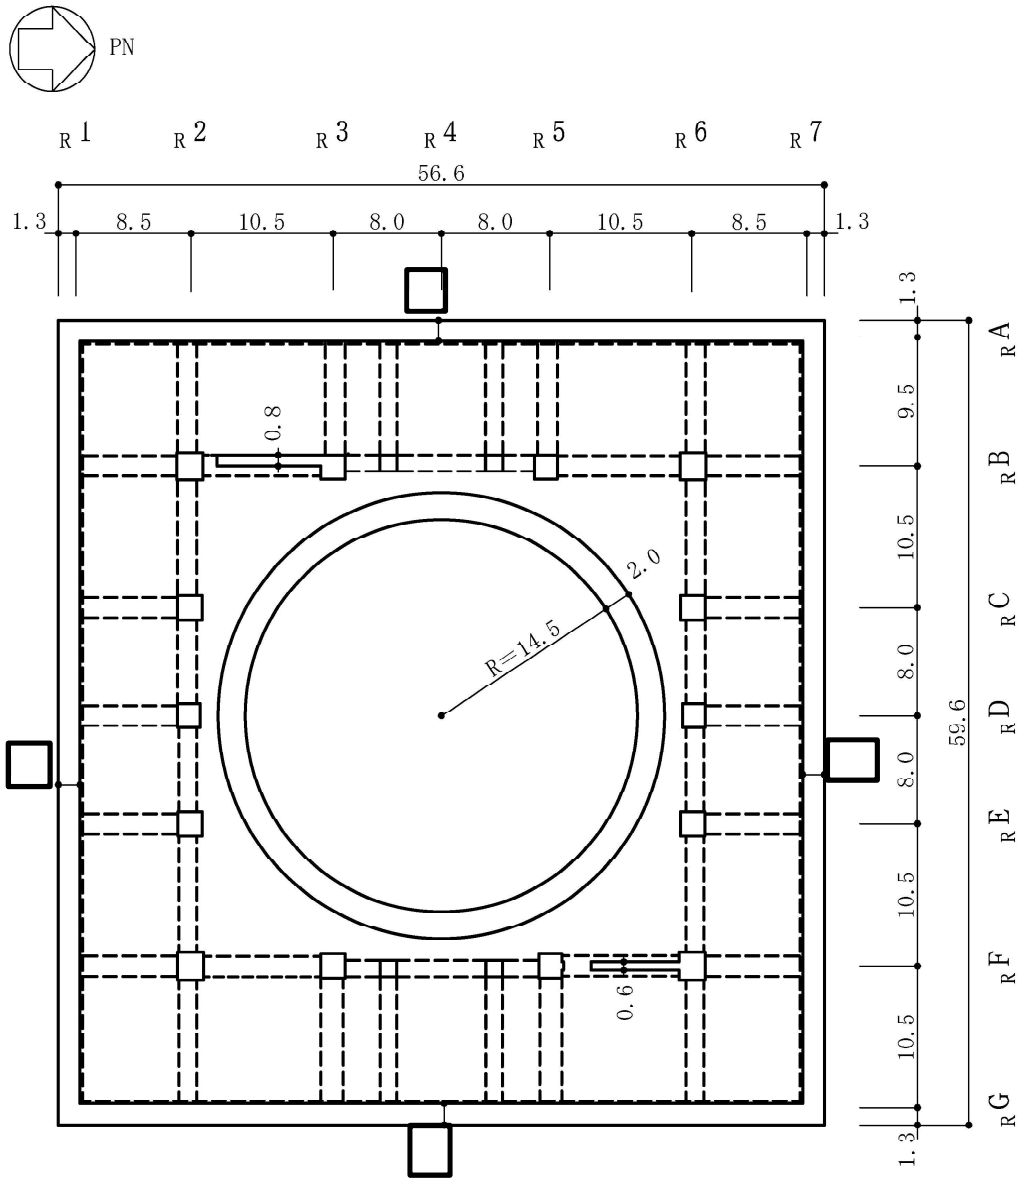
原子炉建屋の概略平面図 (B2F, T. M. S. L. -1.7m) (2/9) (単位 : m)
